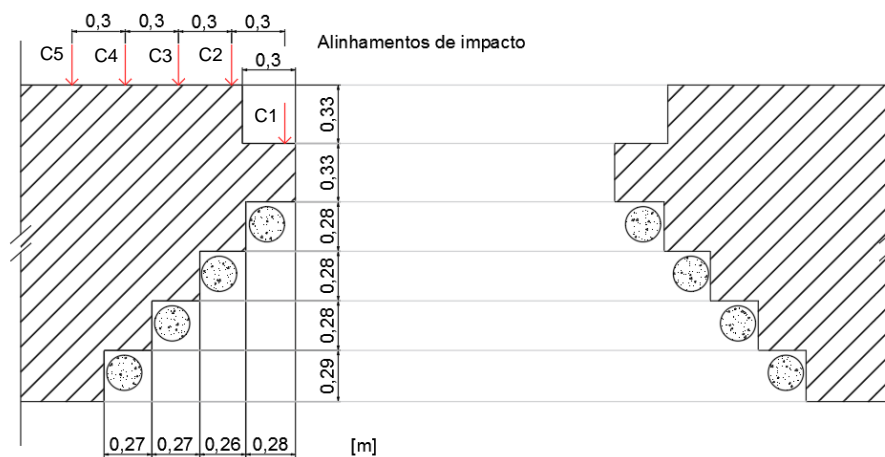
Esquema em planta do ensaio direto realizado no lado esquerdo, do portal da nave.
